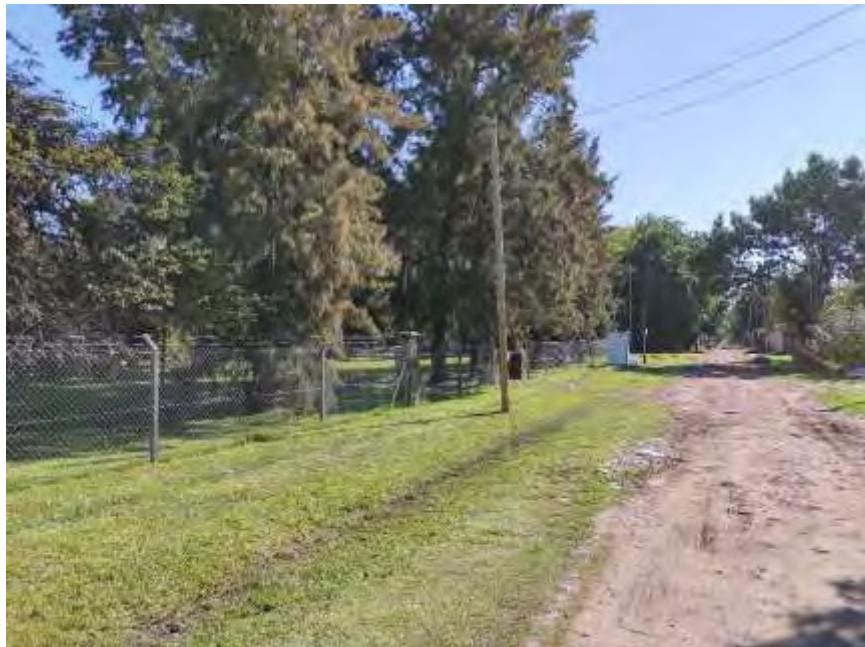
calle Lincoln hacia la calle Entre Ríos.
